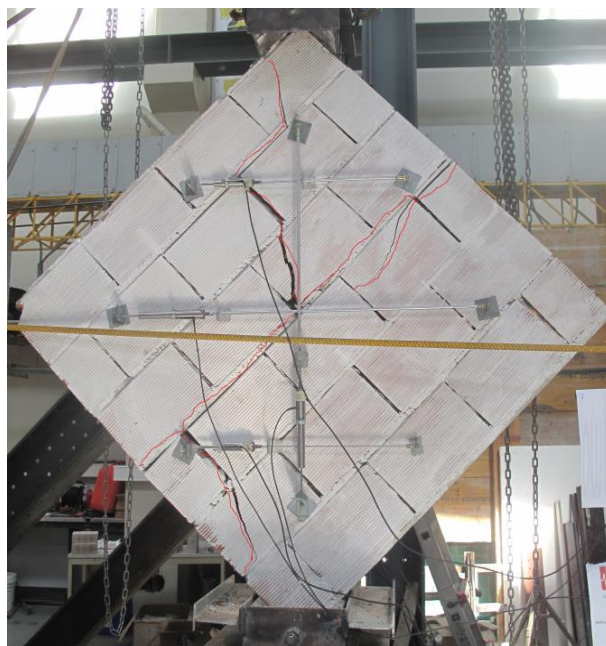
Dano final provocado no provete (CD15\_T3\_CP).
